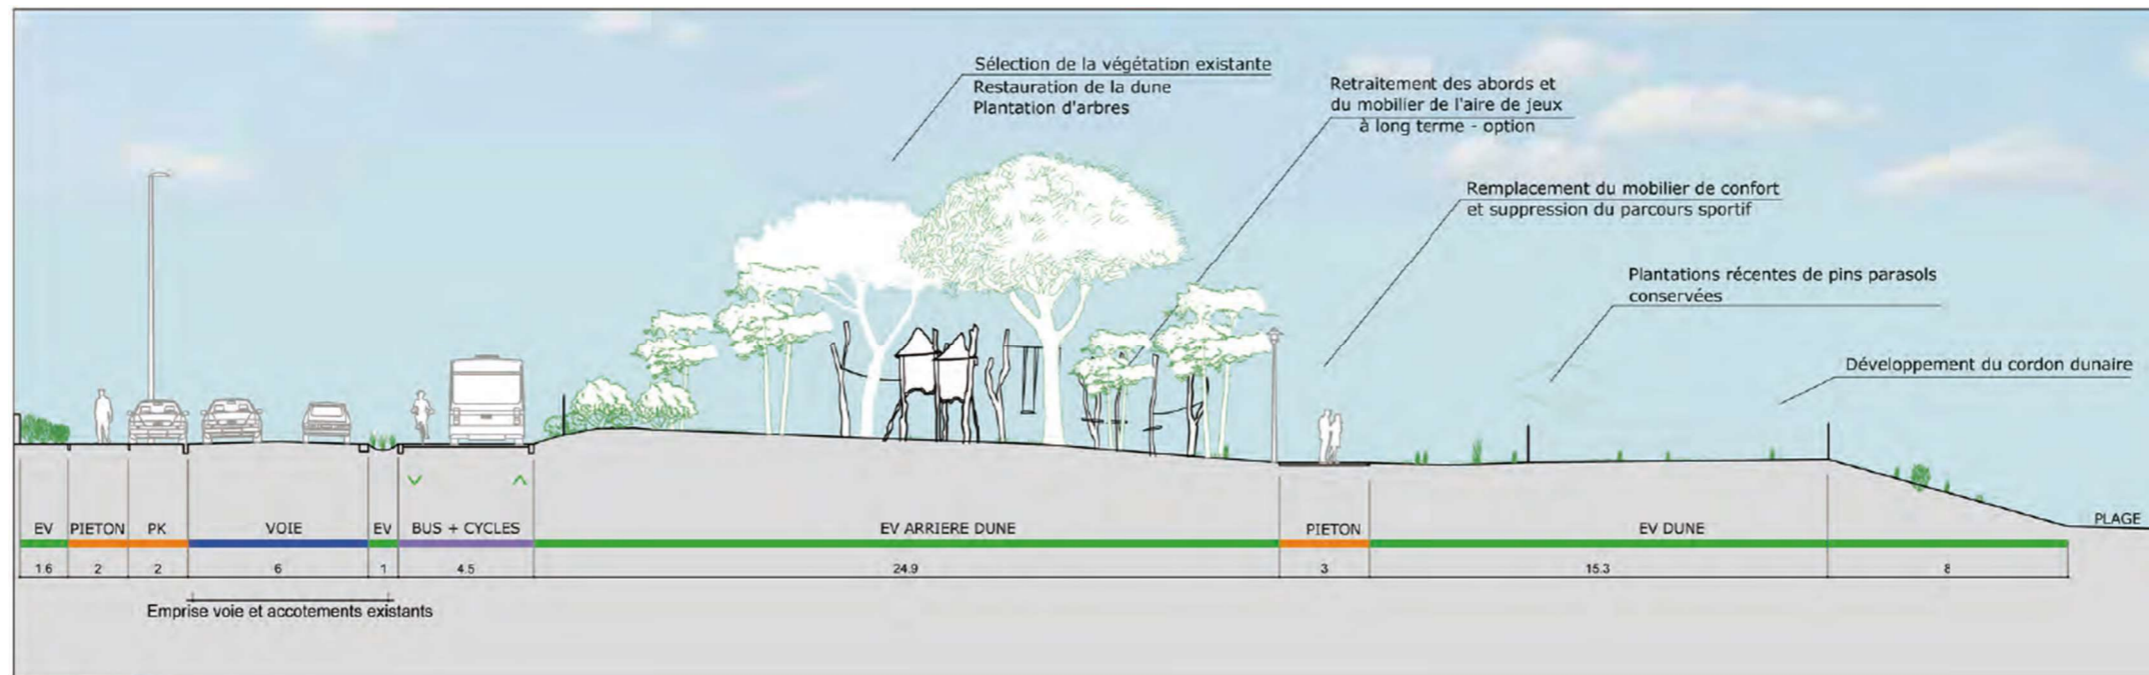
Coupe de principe avenue des dunes – aire de jeux - du projet d'aménagement « 2. Aménagement du site propre et requalification de la plage sud de Rivedoux »
